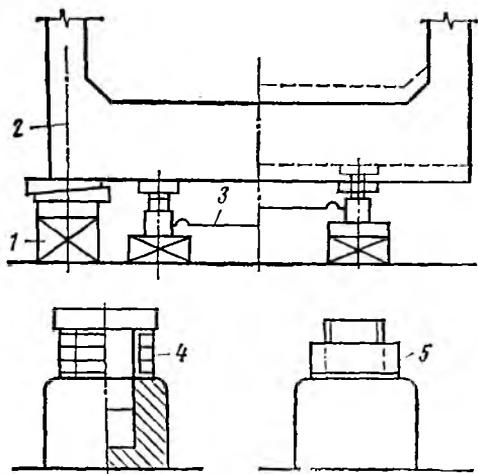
Установка домкратов и клеток для подъема стального пролетного строения и деталь страховки домкрата:
